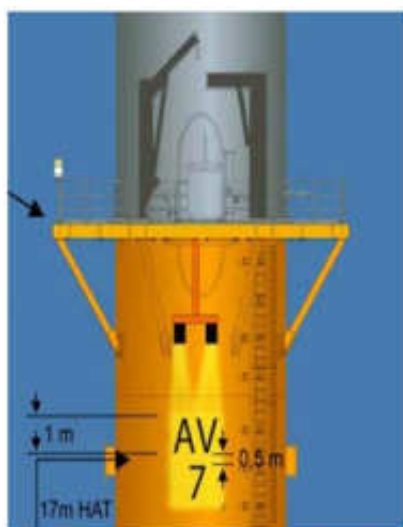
Balisage réglementaire de chaque structure du parc éolien (ici la fondation d'une éolienne)
